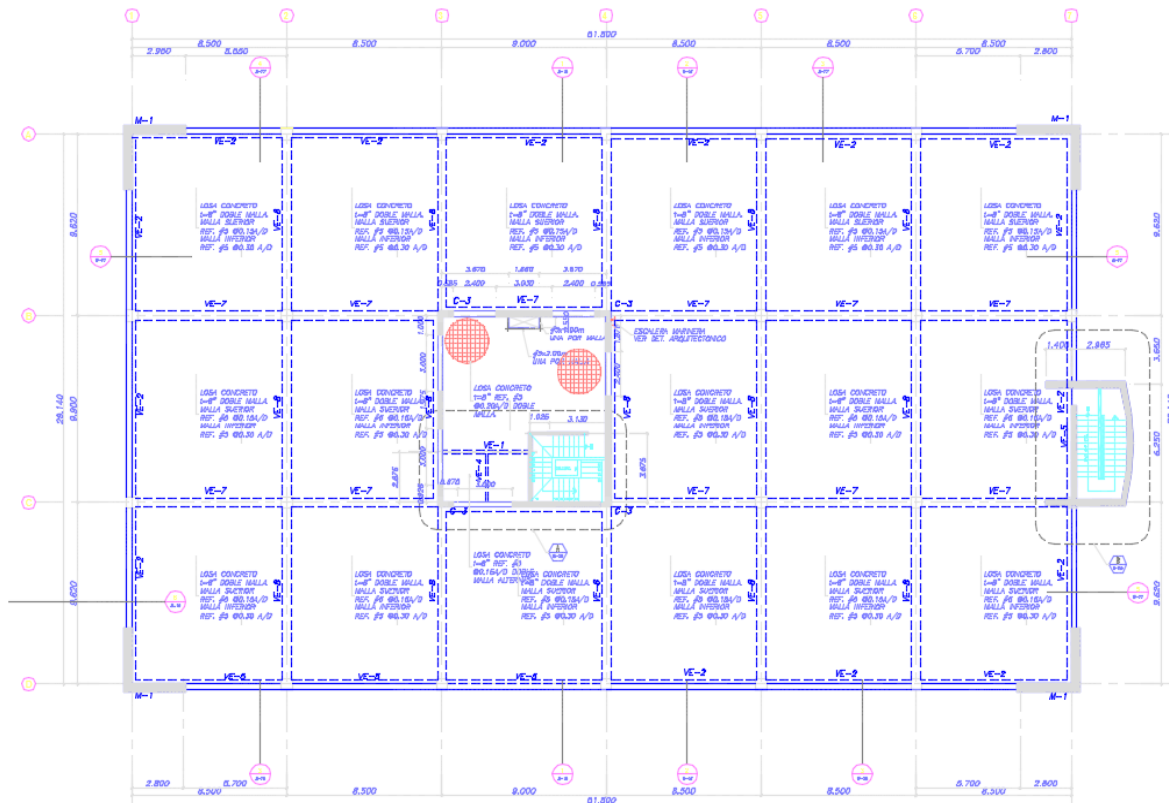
Planta Estructural Entrepiso, Azotea.
